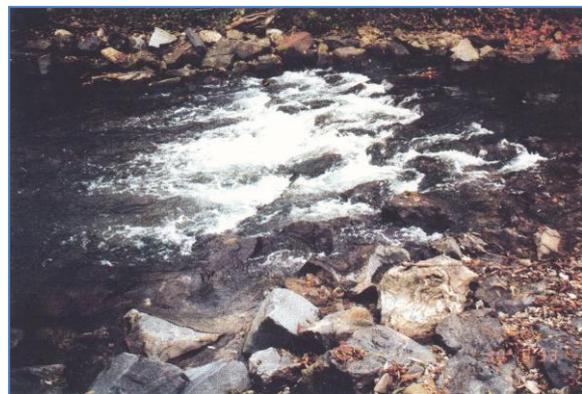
Steilstrecke/ Blocksteinrampe (Quelle: MERWALD)
